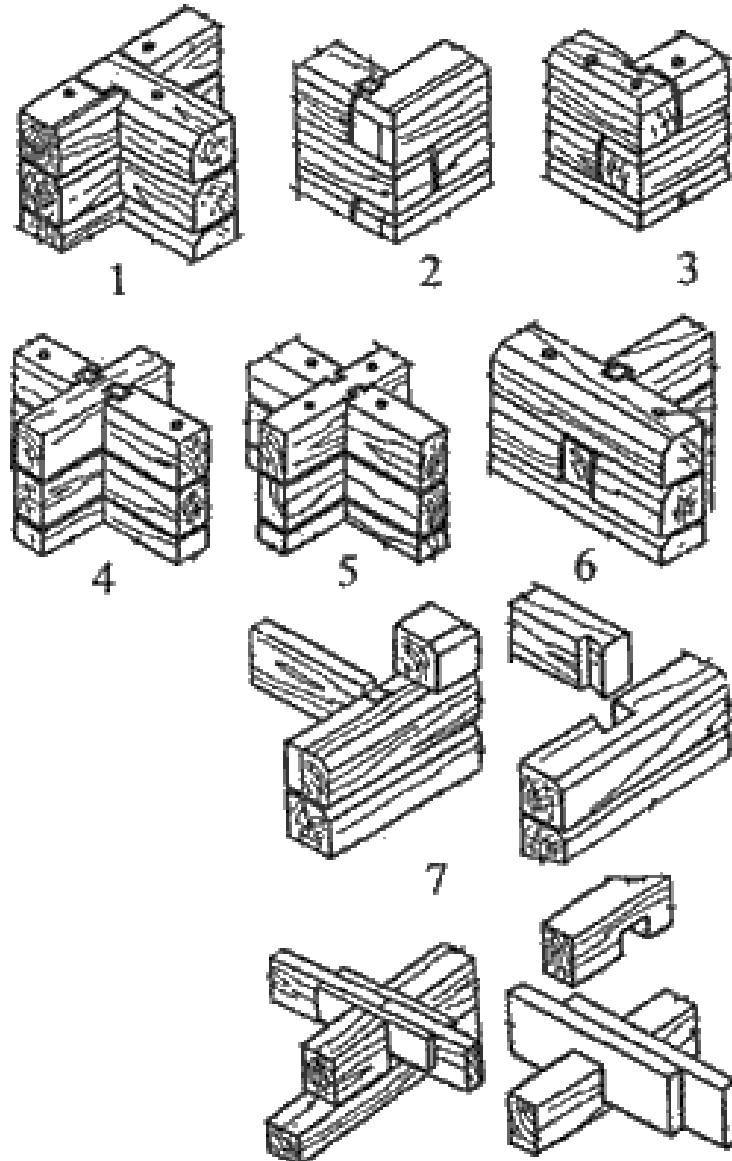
Угловые соединения бруса: 1 — соединение внутренней стены с наружной на шкантах; 2 — соединение на шпонках; 3 — соединение на шкантах; 4 — пересечение стен на шпонках; 5 — пересечение стен на шкантах; 6 — соединение внутренней стены с наружной на шпонках; 7 — соединение балок перекрытий со стенами.
